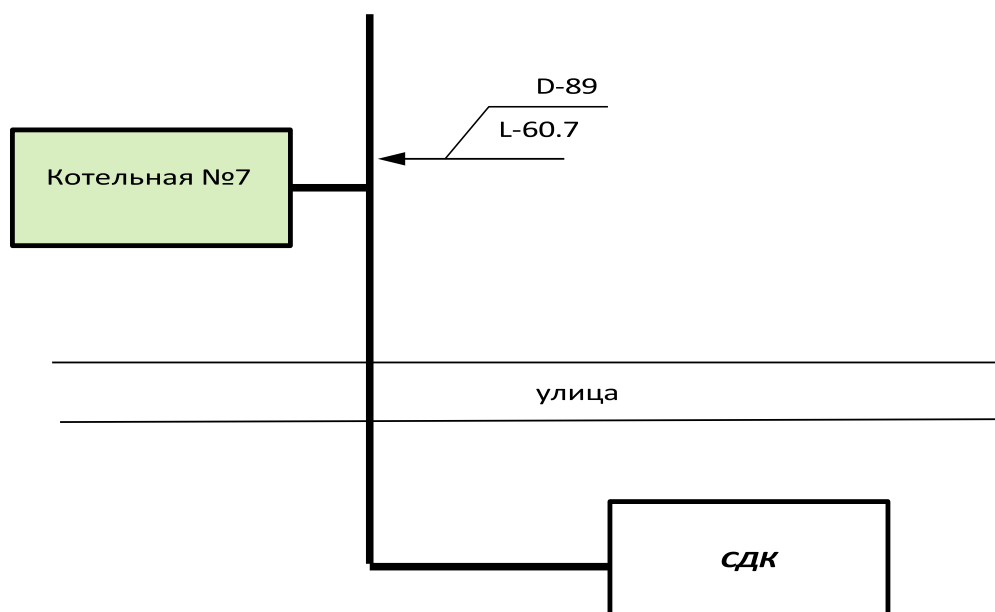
Схема тепловых сетей котельной № 7 (с. Новые Сосны, ул. Школьная, дом 16)
